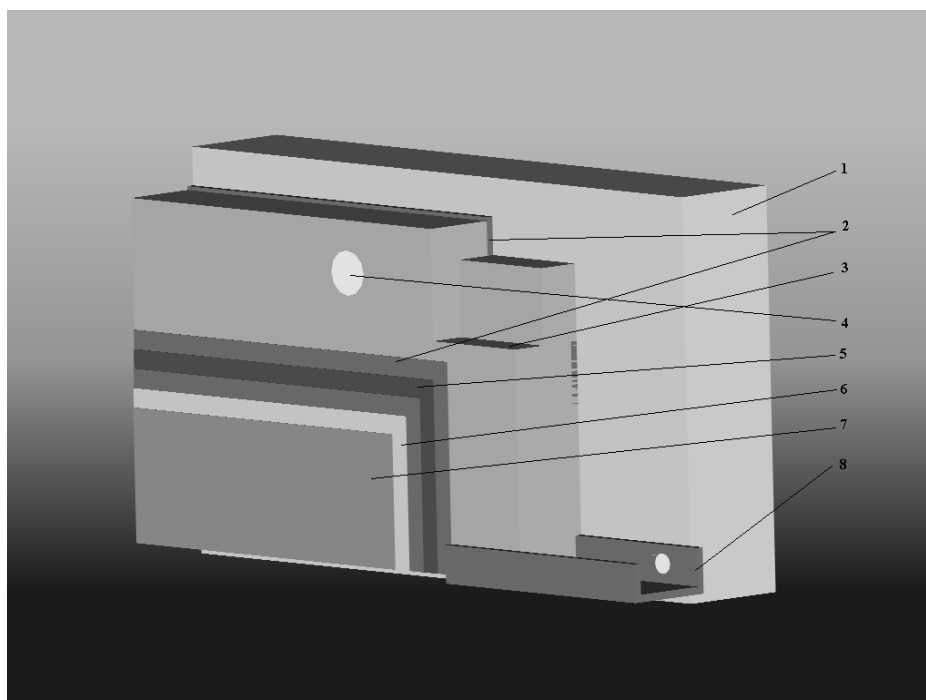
Система наружного утепления фасадов зданий «ФОРПЛАСТ»:
